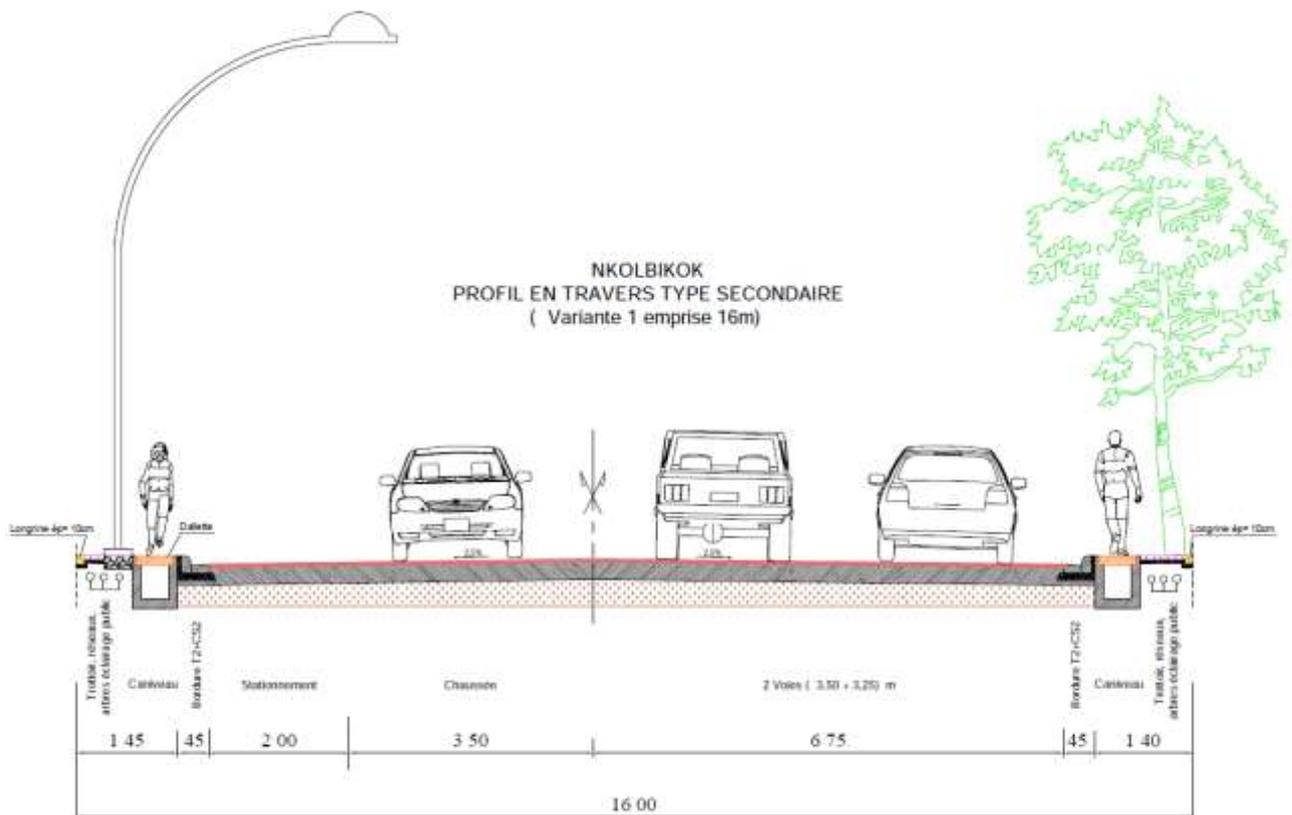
Profil en Travers Type de la Voie Secondaire Projetée (Variante 1)
